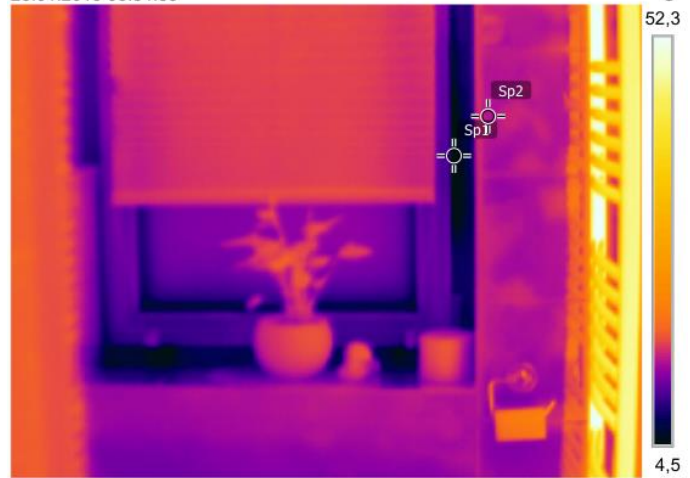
Schlafzimmer OG Decke zum Dachboden konstruktive Wärmebrücke im Dremelpbereich
